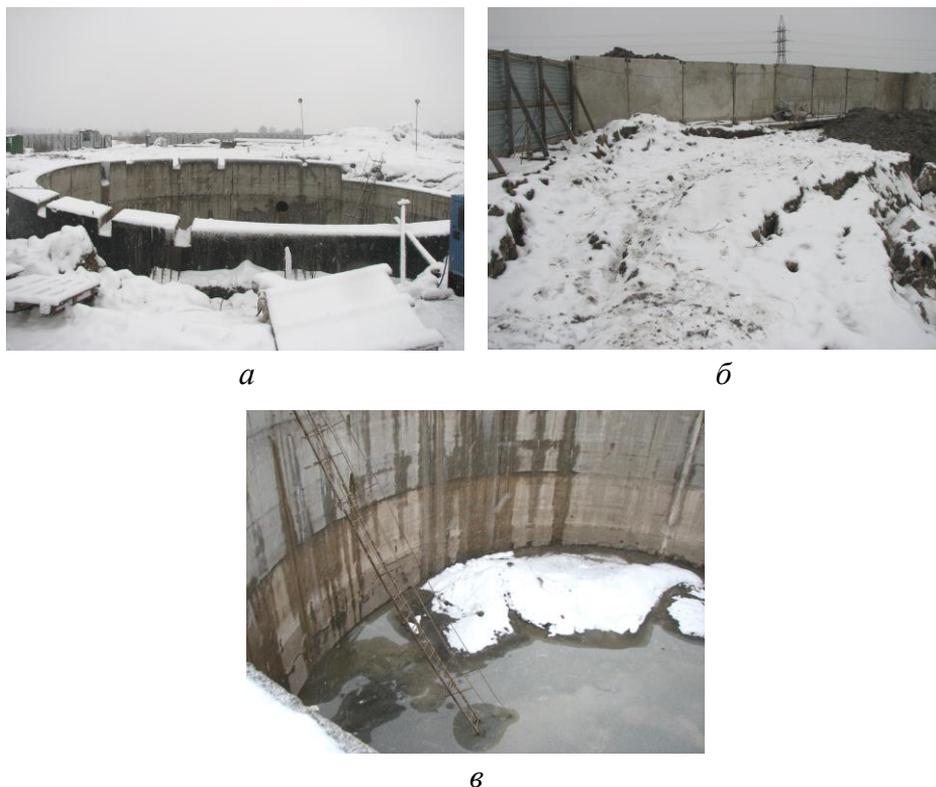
Опускной колодец, погружаемый в слабых грунтах:
